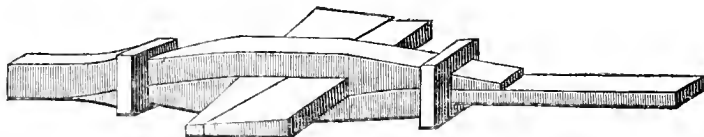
Deuxième forme de l'assemblage à mouffles.
